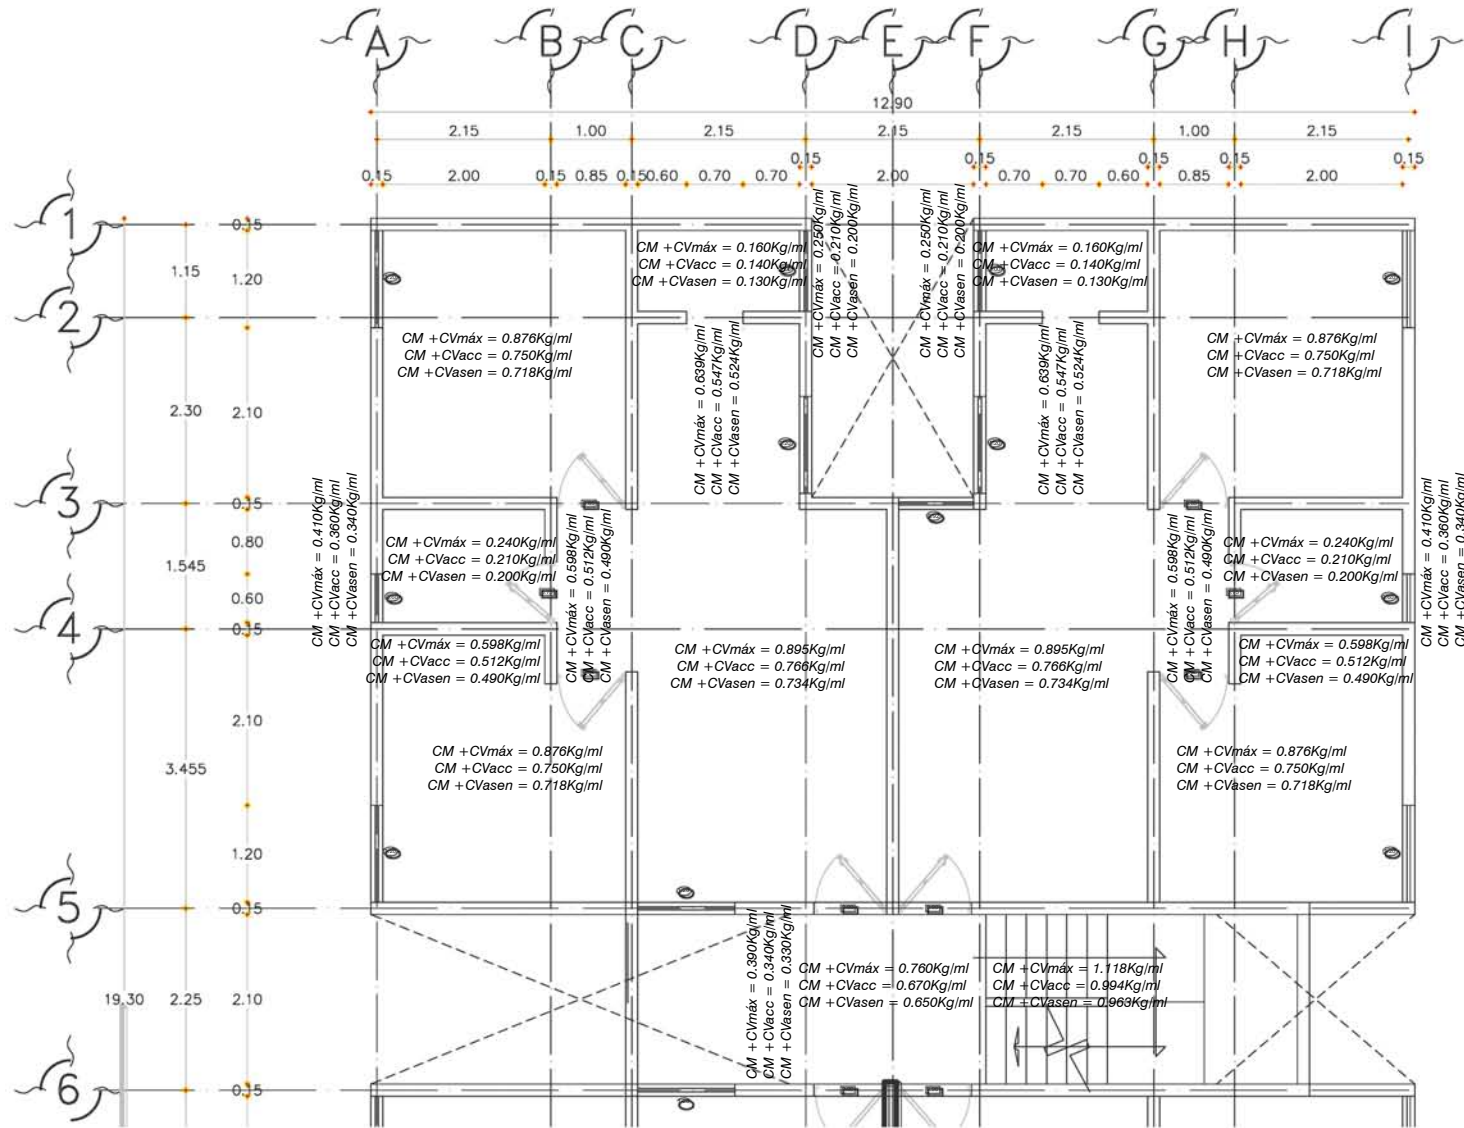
Distribución de cargas en planta tipo (se muestra la mitad de la planta).
